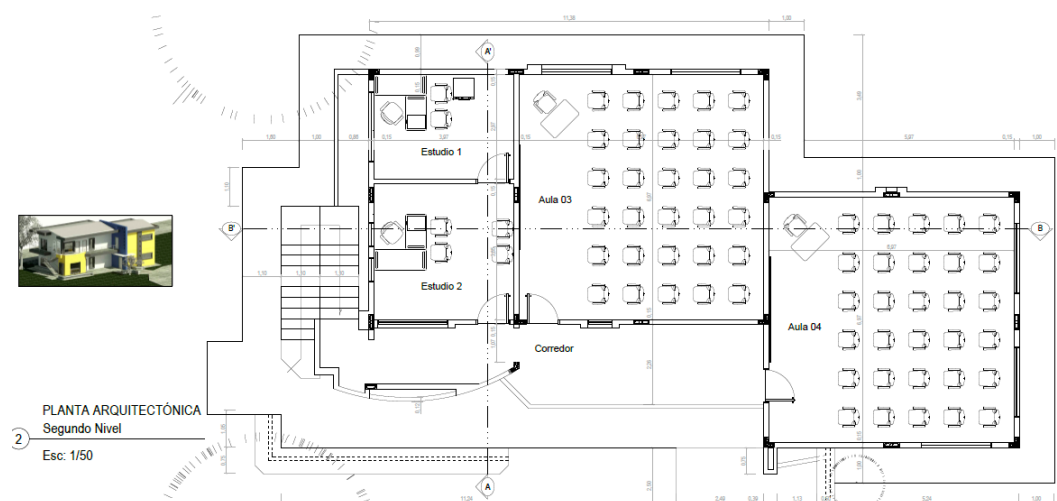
Planta Arquitectónica 2 Primer Piso Actual Cafamaz.
